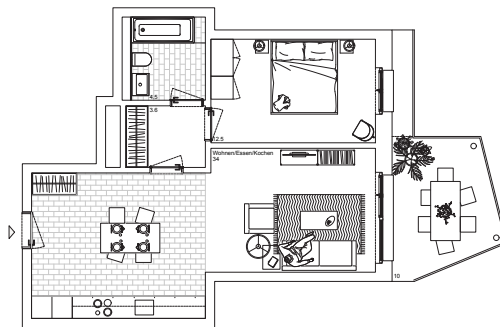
sobremesa: 2.5-Zimmer Wohnung, Haus im Garten
